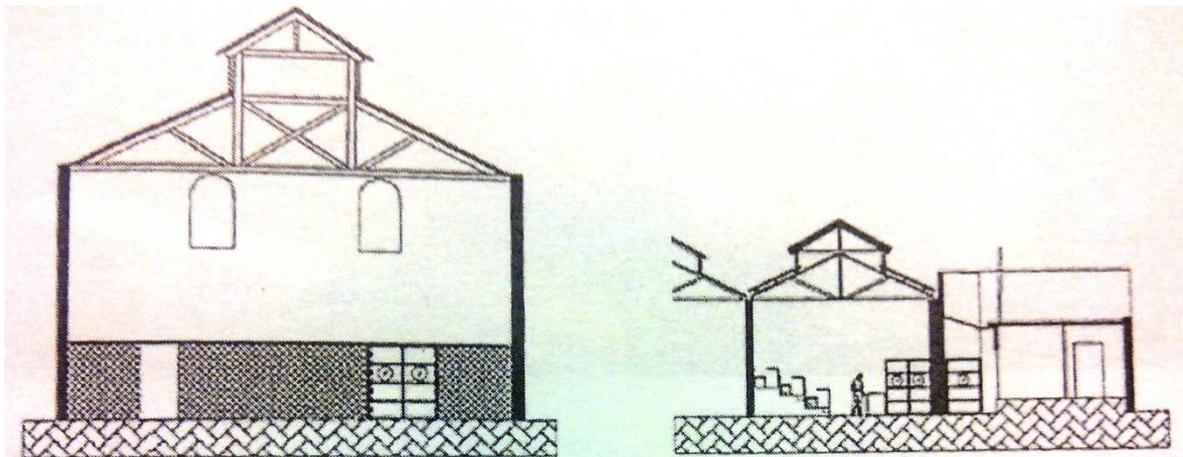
Cortes longitudinais das cozinhas e da cozinha de demonstração
